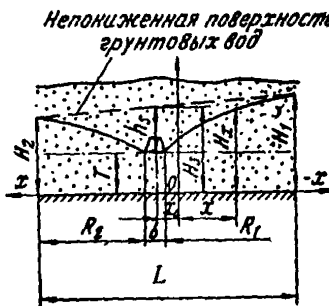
Схема к расчету длинной прямоугольной горизонтальной дрены, расположенной выше подошвы безнапорного пласта на неодинаковых расстояниях от границ питания и стока.
